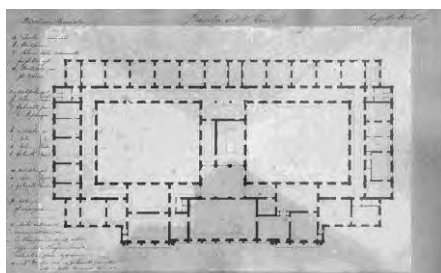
progetto Koch Banca d'Italia pianta piano primo
